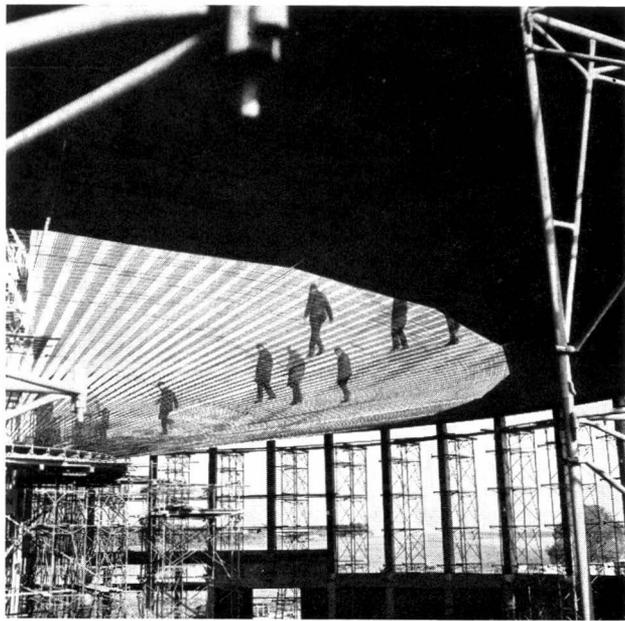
Fertig vorgespannte Dacharmierung mit teilweise bereits montierter Schalung
